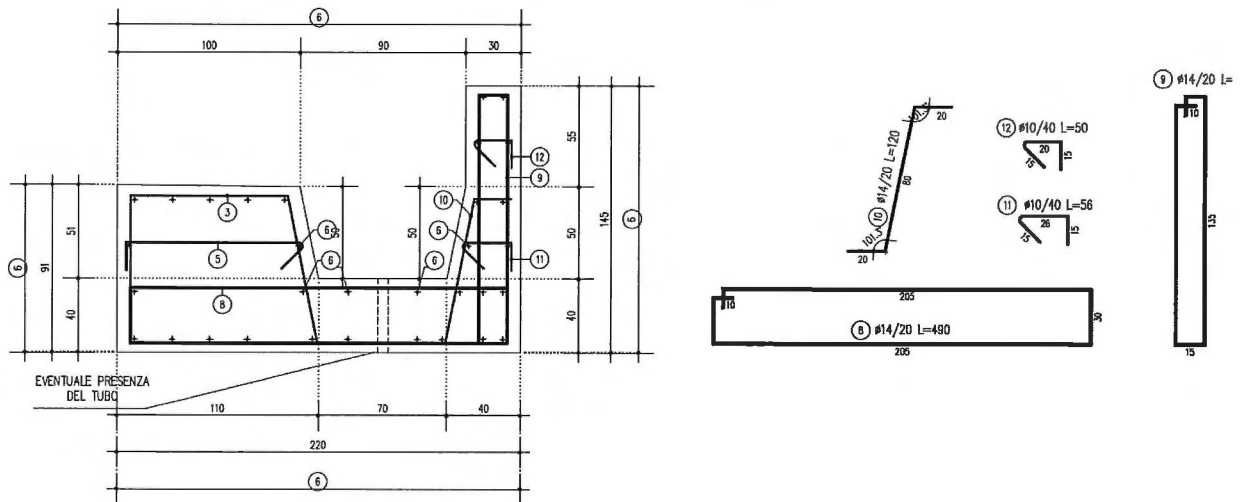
Schema armatura - Sezione Tipo B (Senza Barriere) – Tratto 2
